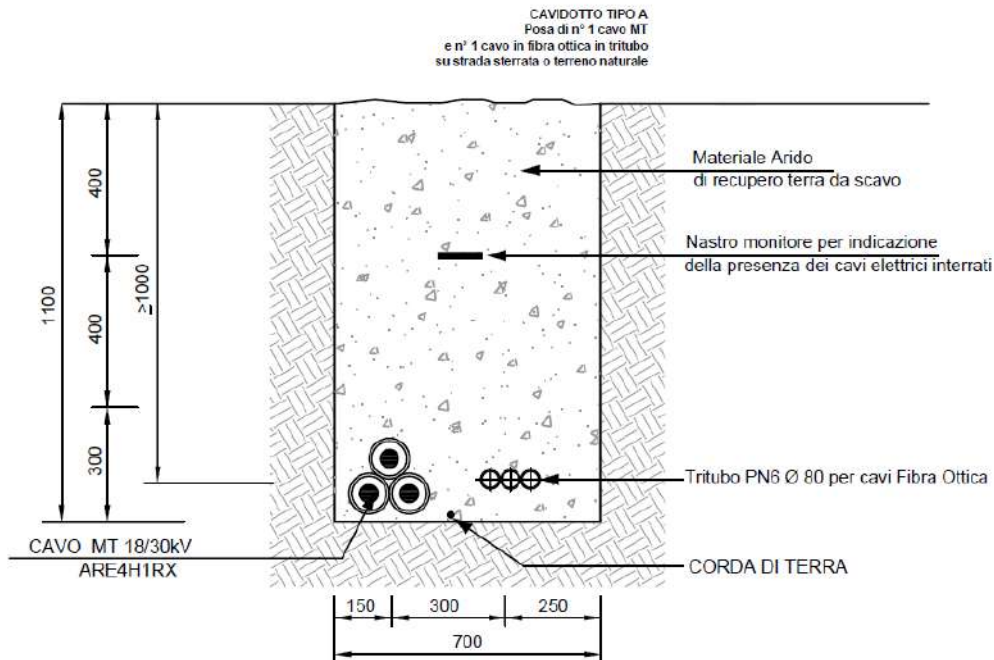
Sezione tipica di posa della linea in cavo su strade sterrate
